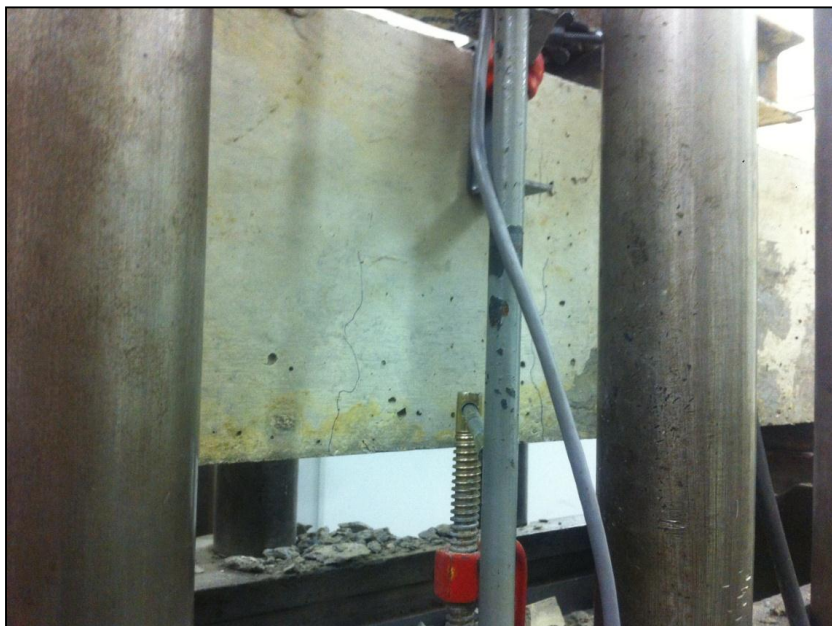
Fissuras verticais no meio da viga V2
